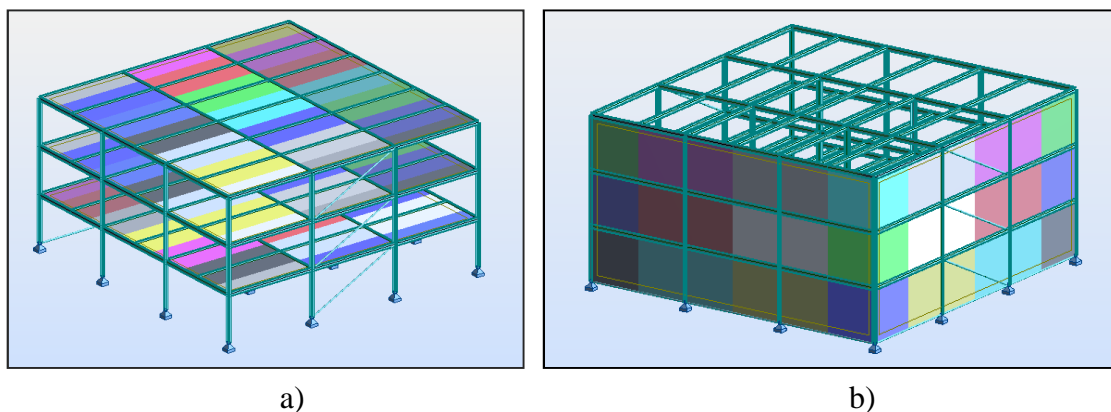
Distribuição de cargas: a) verticais nas vigas b) horizontais nos pilares.
